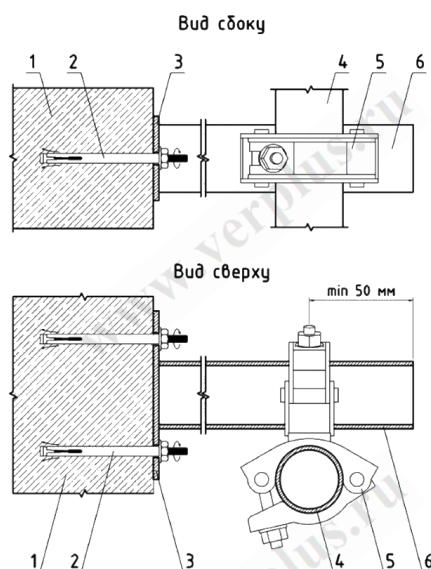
Схема крепления лесов к фасаду здания
